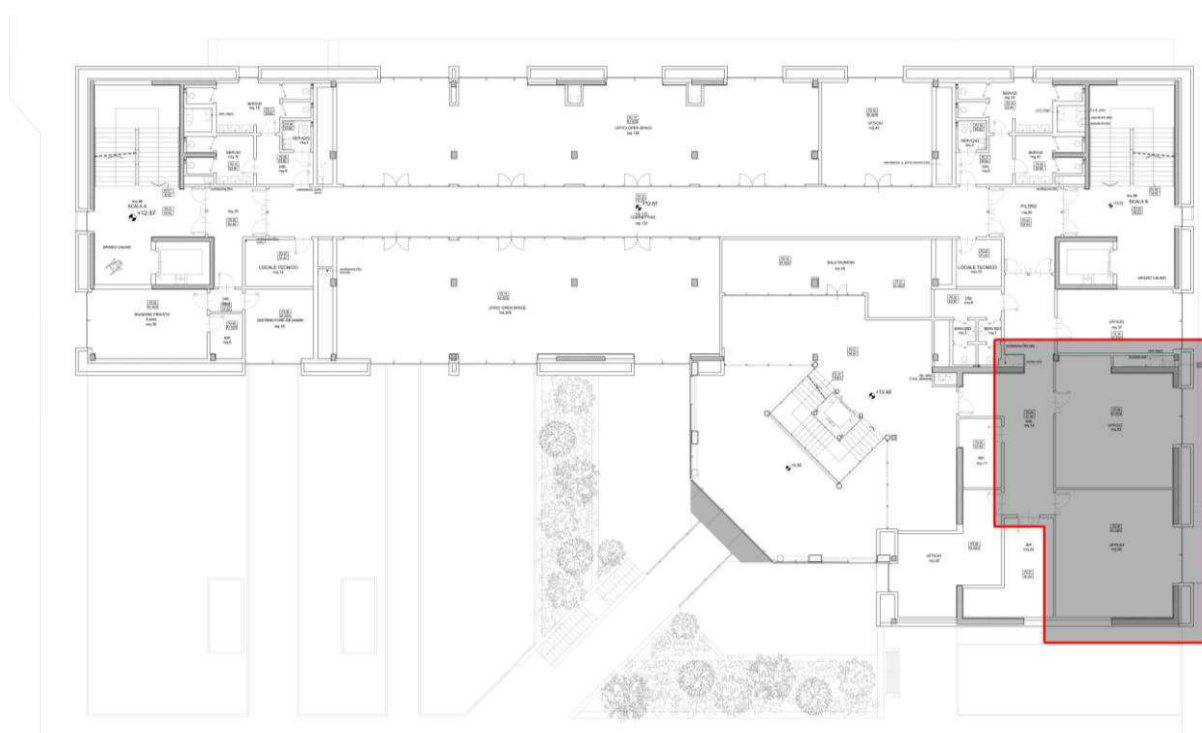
Pianta secondo piano con individuazione degli ambienti analizzati.
